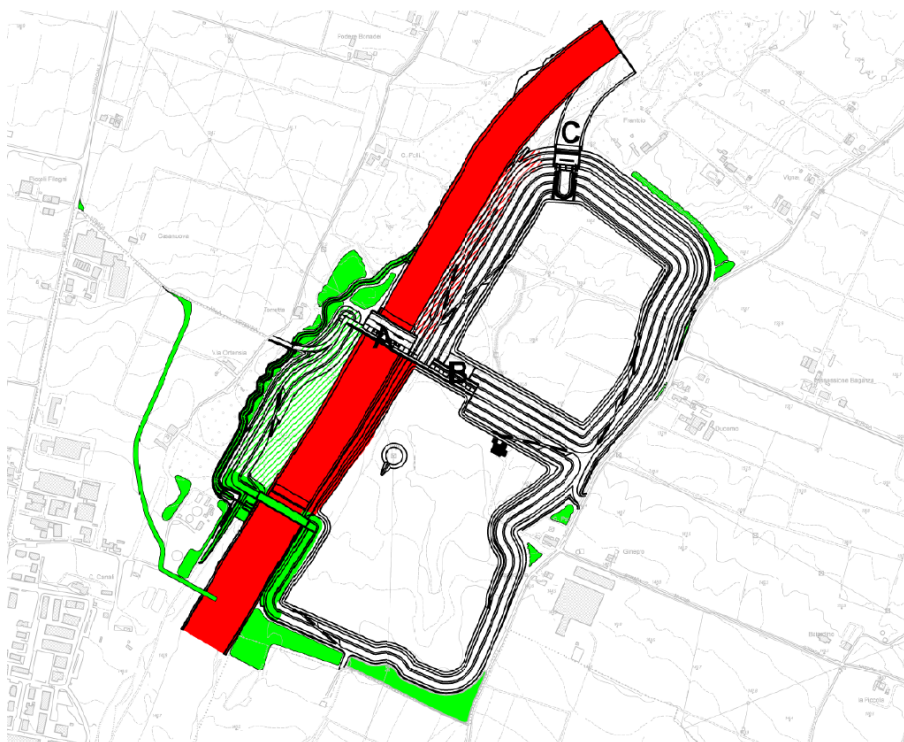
Rappresentazione planimetrica della FASE 3
